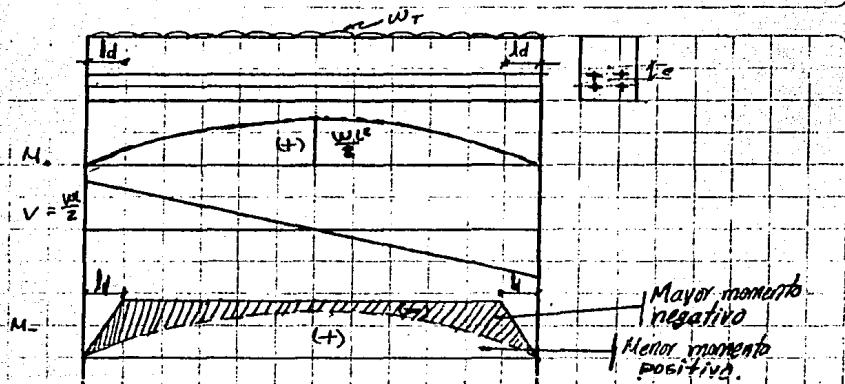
Longitud de desarrollo en una viga pretenada.
